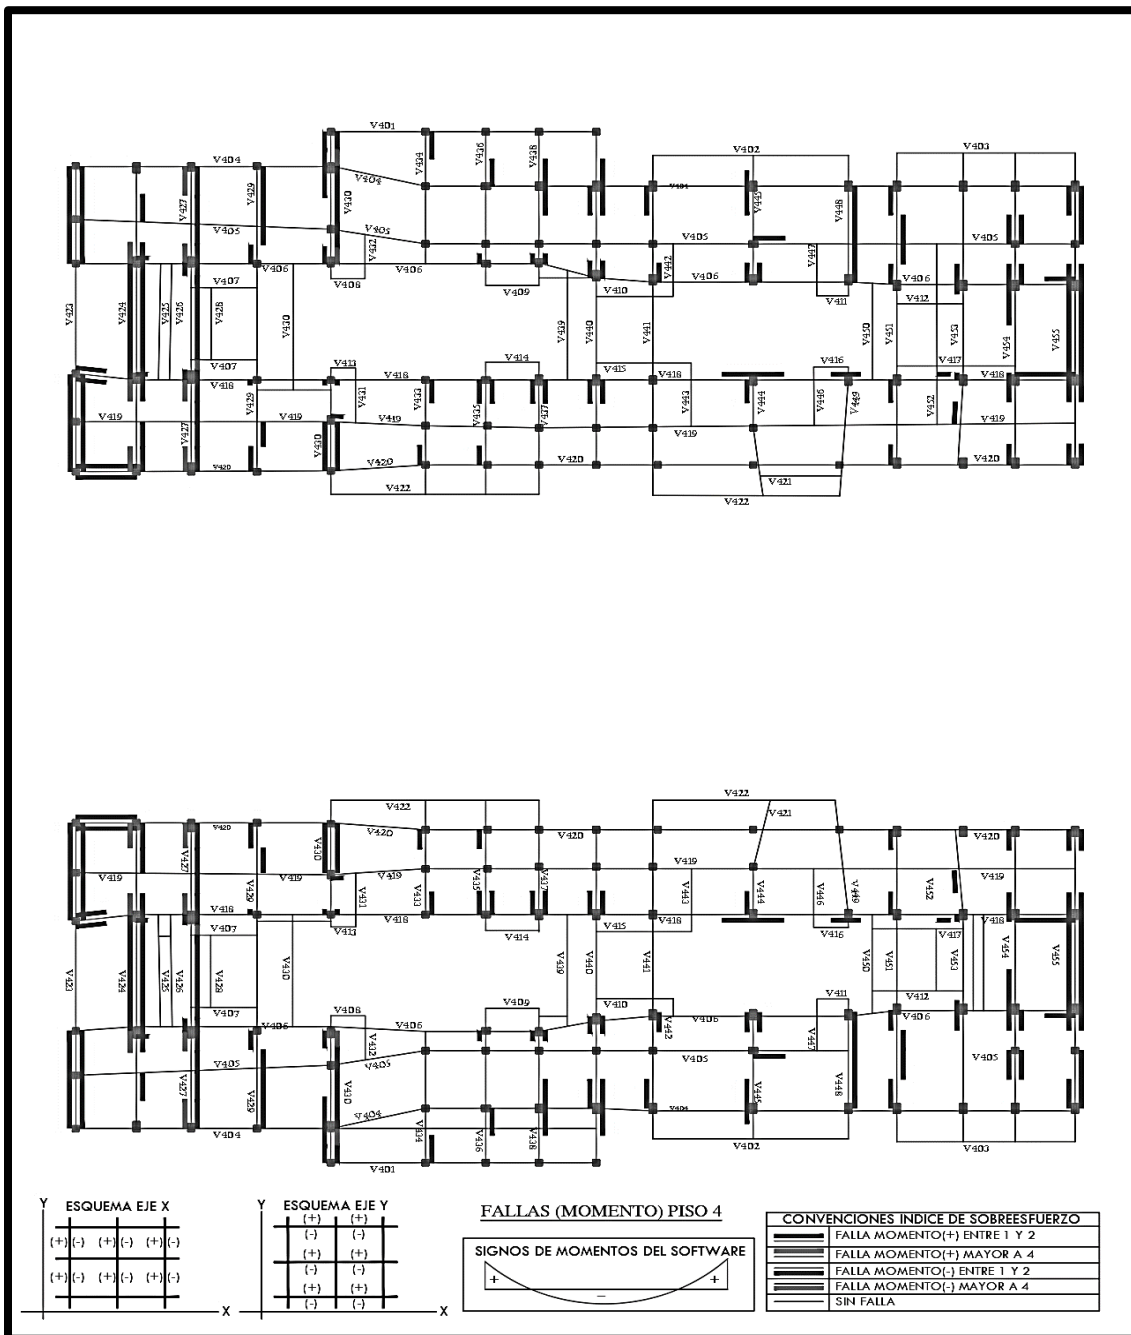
Plano secuencia de fallas (Momento) piso 4. Fuente: Los autores
